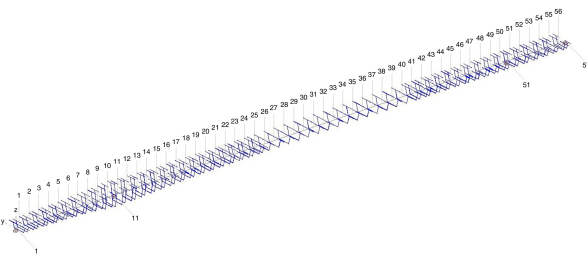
Modelización del Puente de la Cartuja: viga cajón continua de sección variable, con tablero ortótropo
